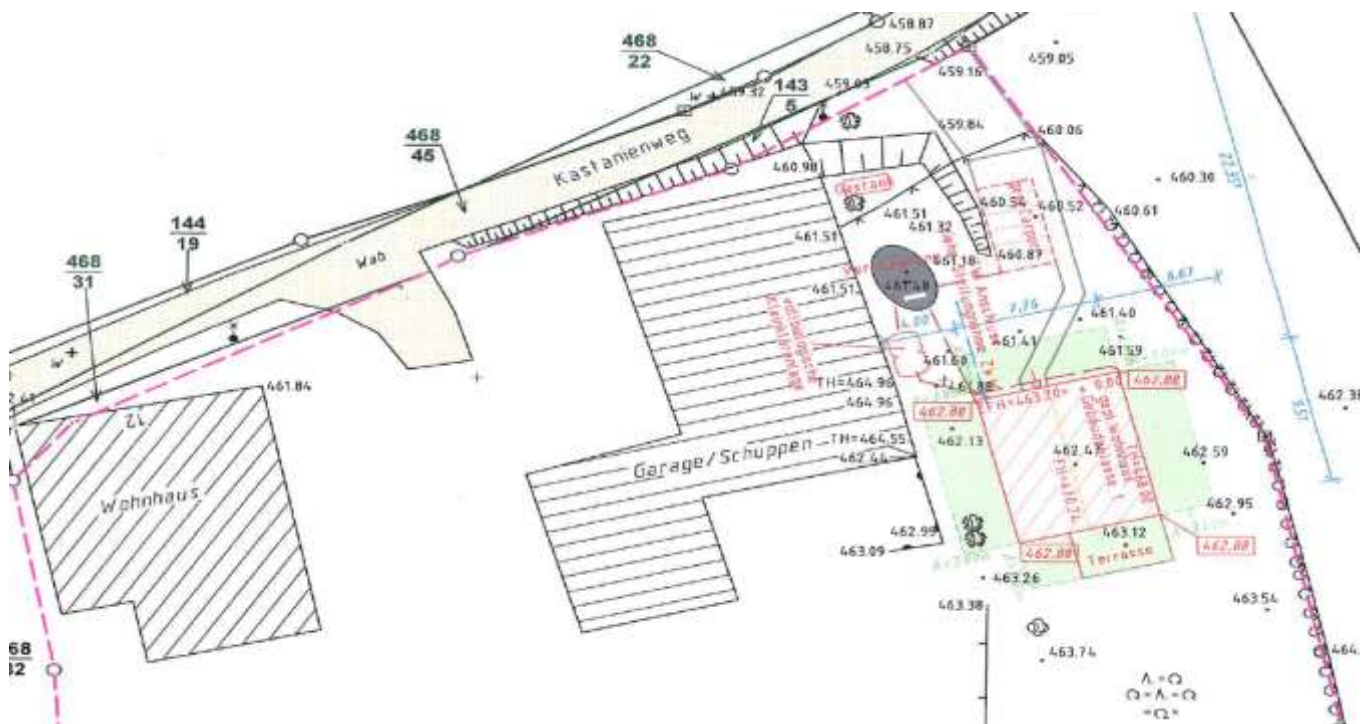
Ausschnitt Lageplan zum Bauantrag vom 28.03.2022
